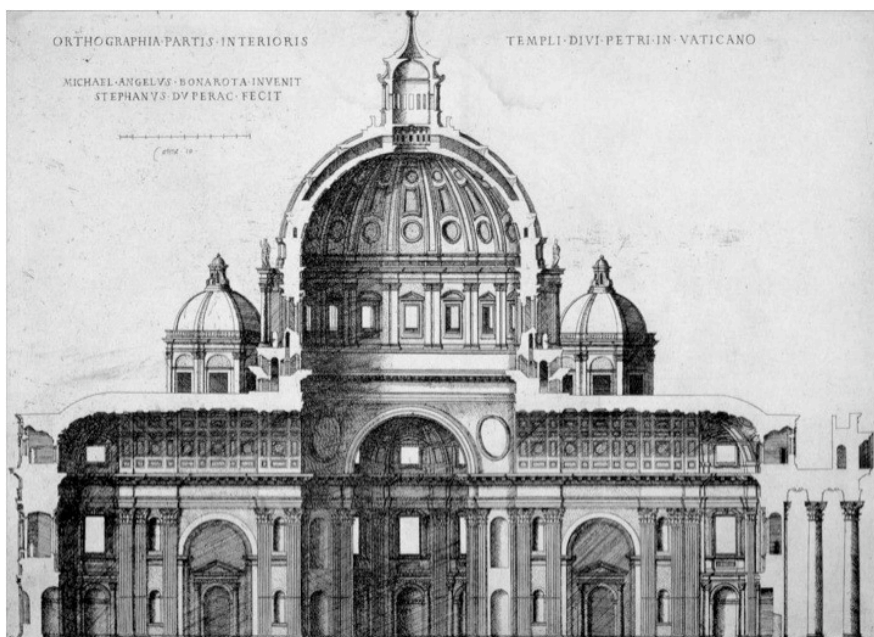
Sezione del Tempio Vaticano secondo il progetto di Michelangelo.
